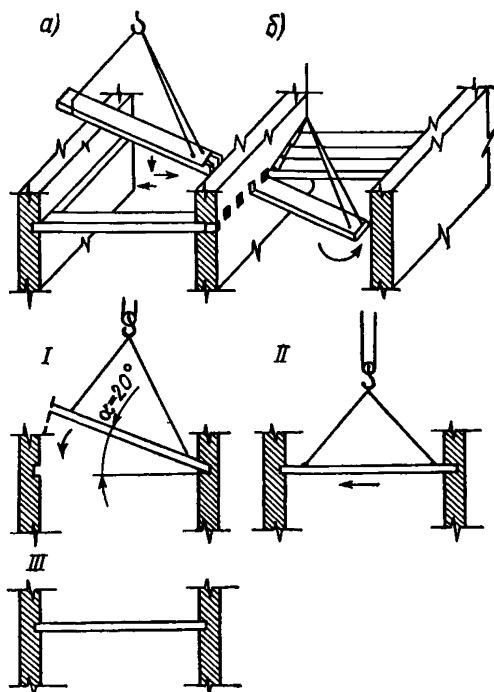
Схемы монтажа железобетонных настилов с выпускными ребрами
